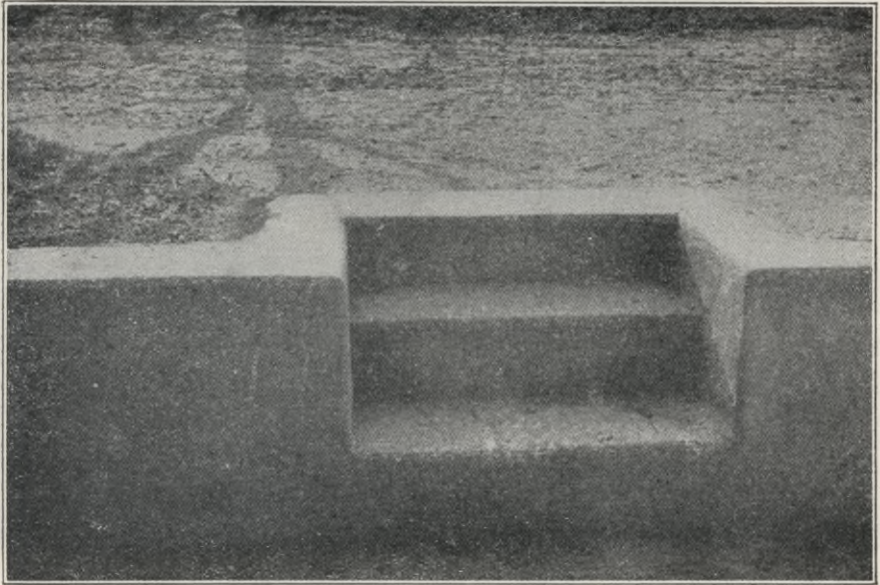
Böschungsbefestigung aus Beton mit Treppe.
